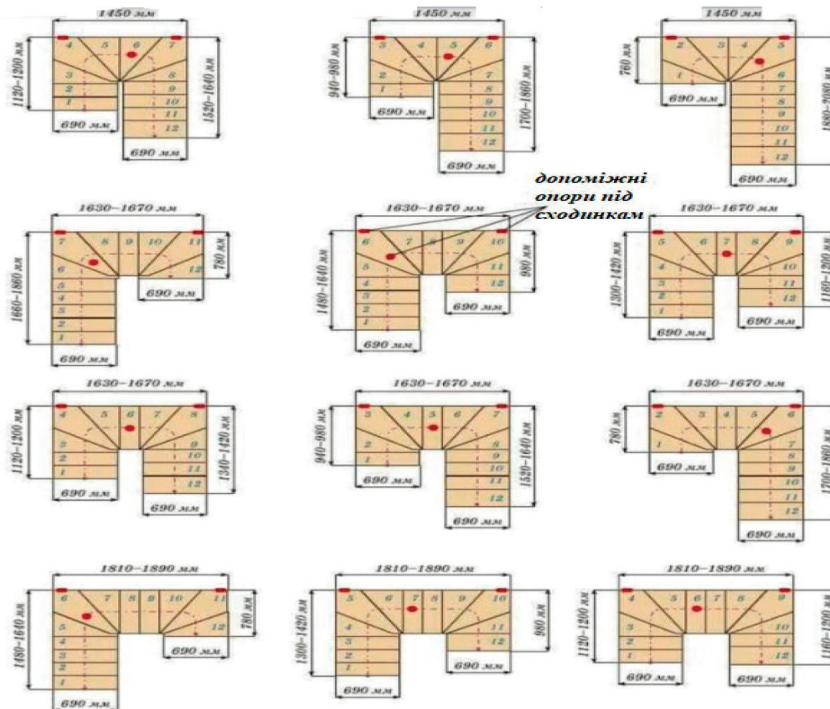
Планувальні рішення сходів у будівлях підвищеної поверховості:
